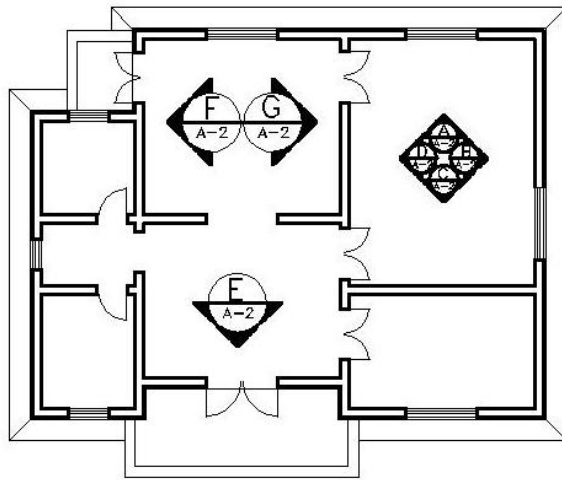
平面图上内视符号(带索引)应用示例
